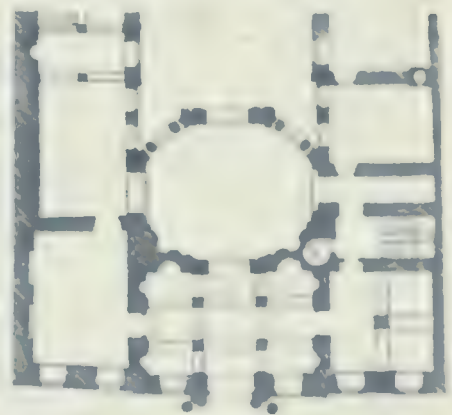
Grundriß der Eingangshalle des Daunschen (jetzt Kinskyschen) Palastes in Wien, nach Alb. Niemann, s. nebenan
